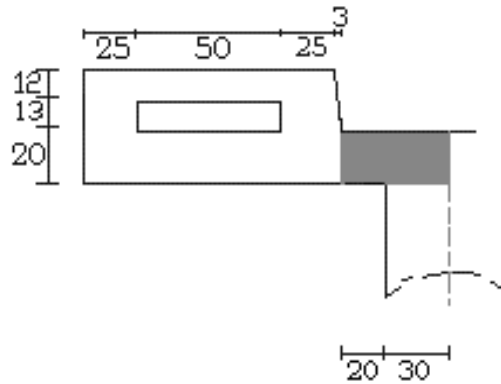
Ancho de losa en voladizo. Dimensiones en (cm).
